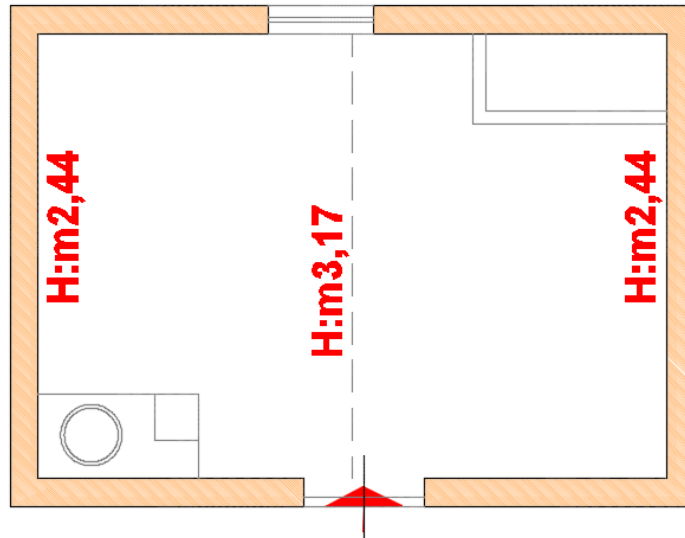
Planimetria manufatto ricadente sulla p.Illa 175
